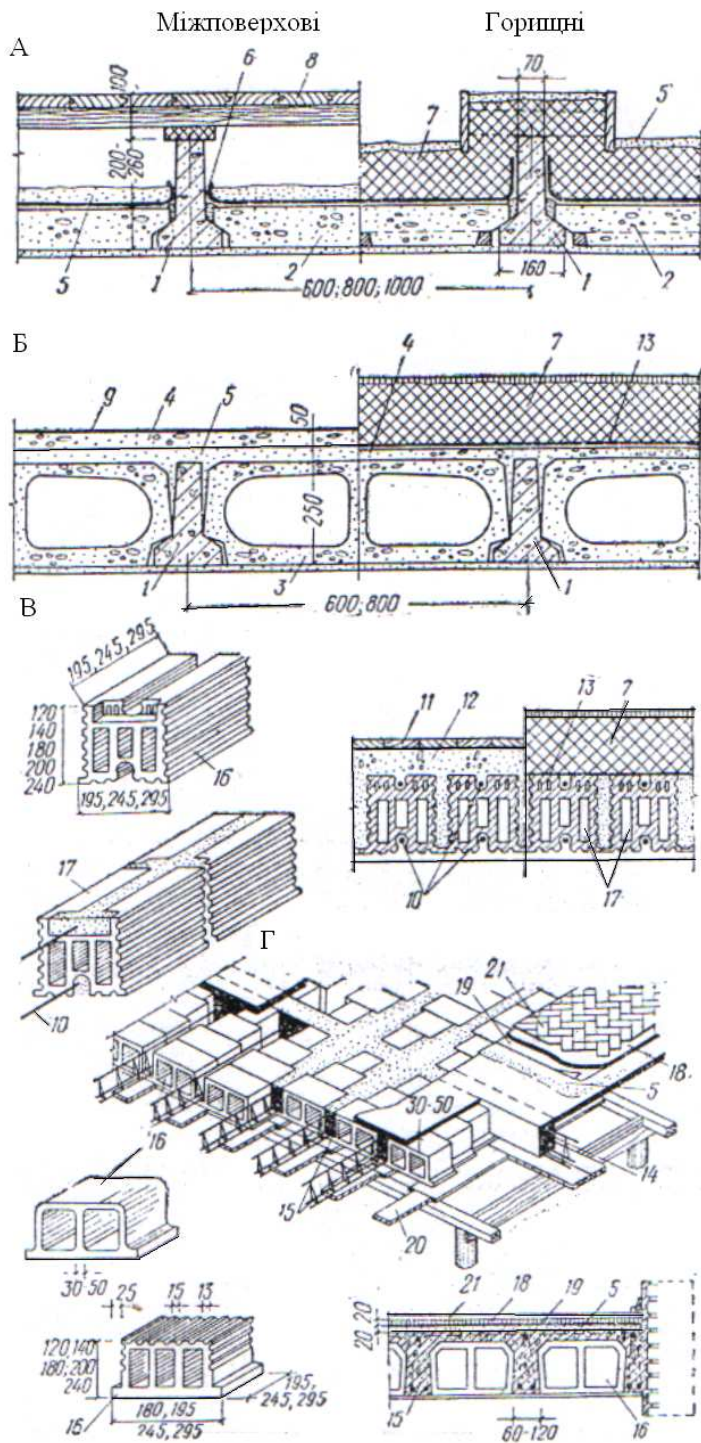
Переkritтя по залізобетонних балках: А – залізобетонні балки з гіпсовими плитами; Б – теж, з легкобетонними вкладишами; В – кера-мічне переkritтя з збірних армокера-мічних балок; Г – збірно-монолітні кера-мічні переkritтя; 1 – залізобетонна таврова балка; 2 – плита гіпсова або лег-кобетонна; 3 – двохпустотний легкобетон-ний вкладиш; 4 – цементний розчин; 5 – пісок не менше 20мм; 6 – толь; 7 – утеп-лювач; 8 – дощата підлога по лагах; 9 – підлога із лінолеума; 10 – арматура з круглої сталі; 11 – паркт по мастиці; 12 – шлакобетон; 13 – пароізоляція; 14 – залі-зобетонний прогон; 15 – залізобетонні ребра-балки; 16 – пустотілий блок-вкладиш; 17 – збірна армо-керамічна балка; 18 – асфальт; 19 – руберойд; 20 – опалубка у вигляді розріженого настилу; 21 - паркет
